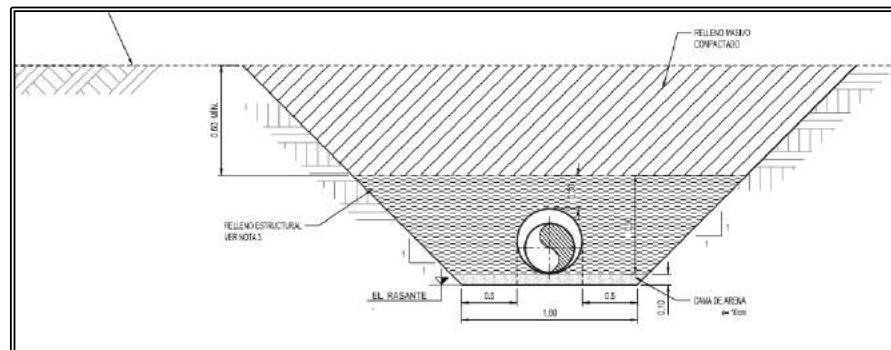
Sección Típica de Trincheras para Línea de Tubería hacia Poza Sur
